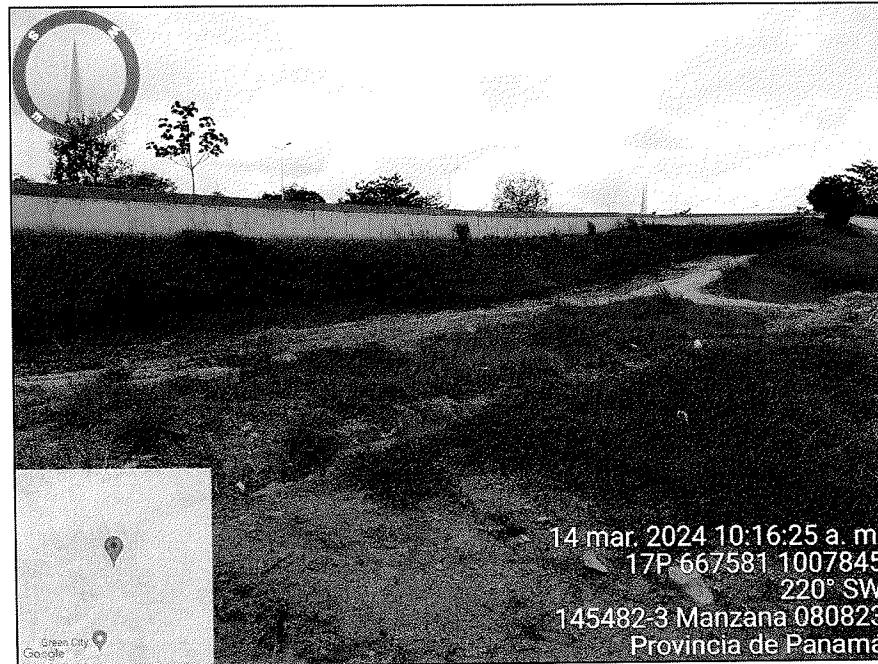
Vista frontal del área de construcción de los Modelos Aquamarina Luxe.
